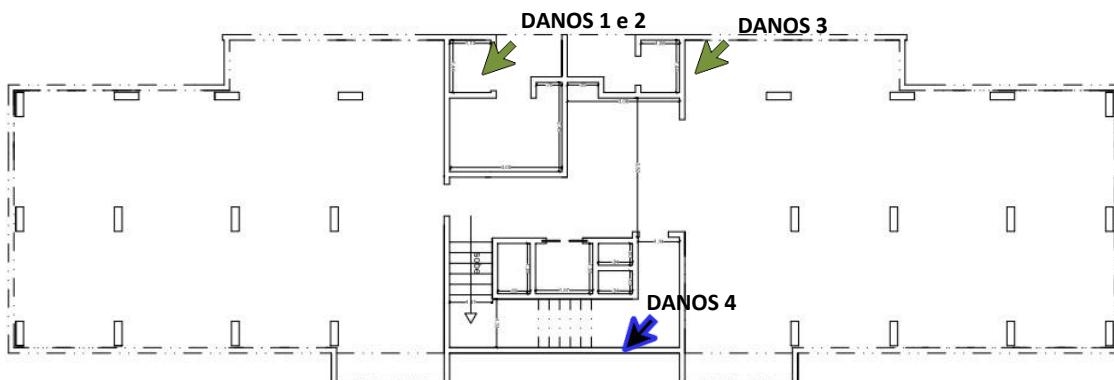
Planta Baixa (croqui) do pavimento térreo – Bloco C – Cond. Armando Lôbo.
